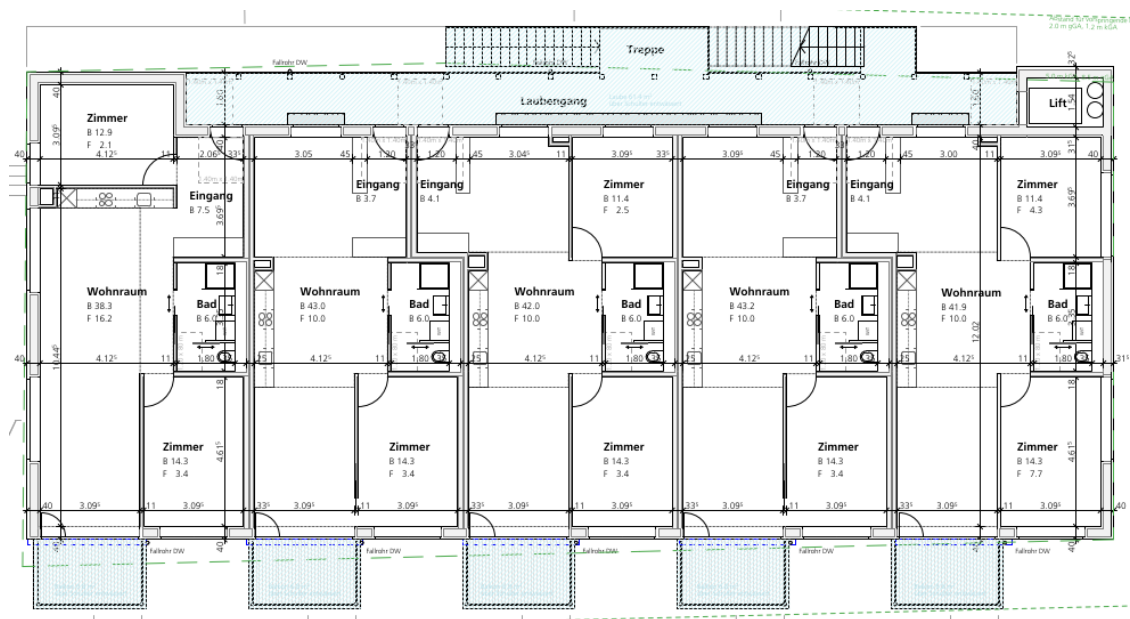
Grundriss 1.OG (ohne Massstab)
